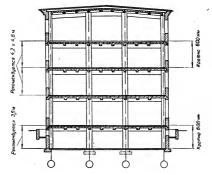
9. Высоты этажей многоэтажных зданий.
